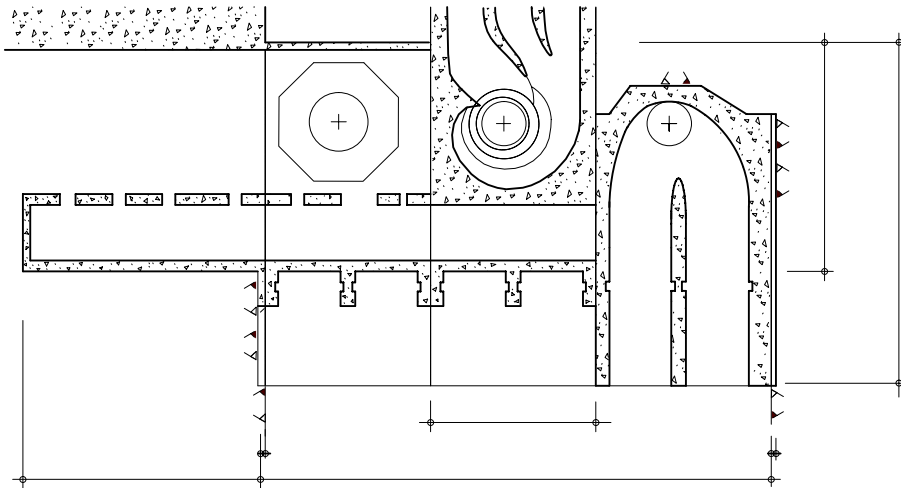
Planta da casa de força e área de montagem – Turbina Kaplan com caixa semi-espiral de concreto.
